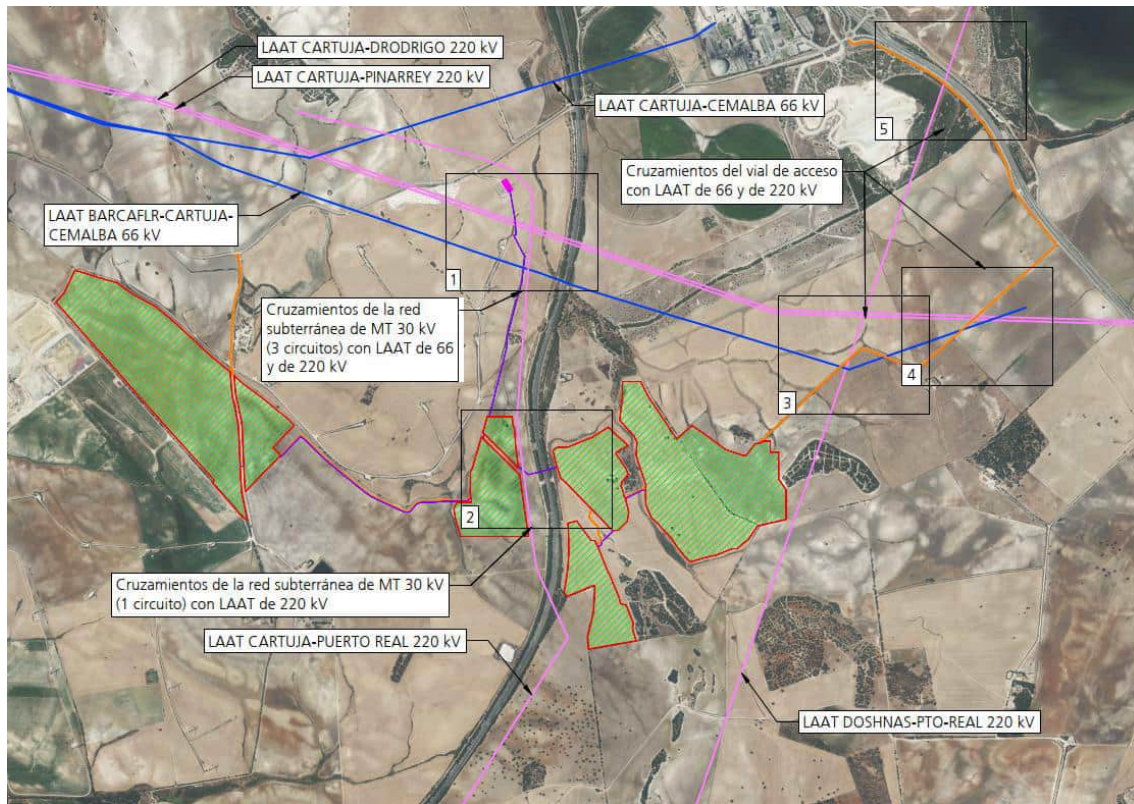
Líneas eléctricas pertenecientes a REE próximas a la planta fotovoltaica. Fuente: Elaboración Propia.
